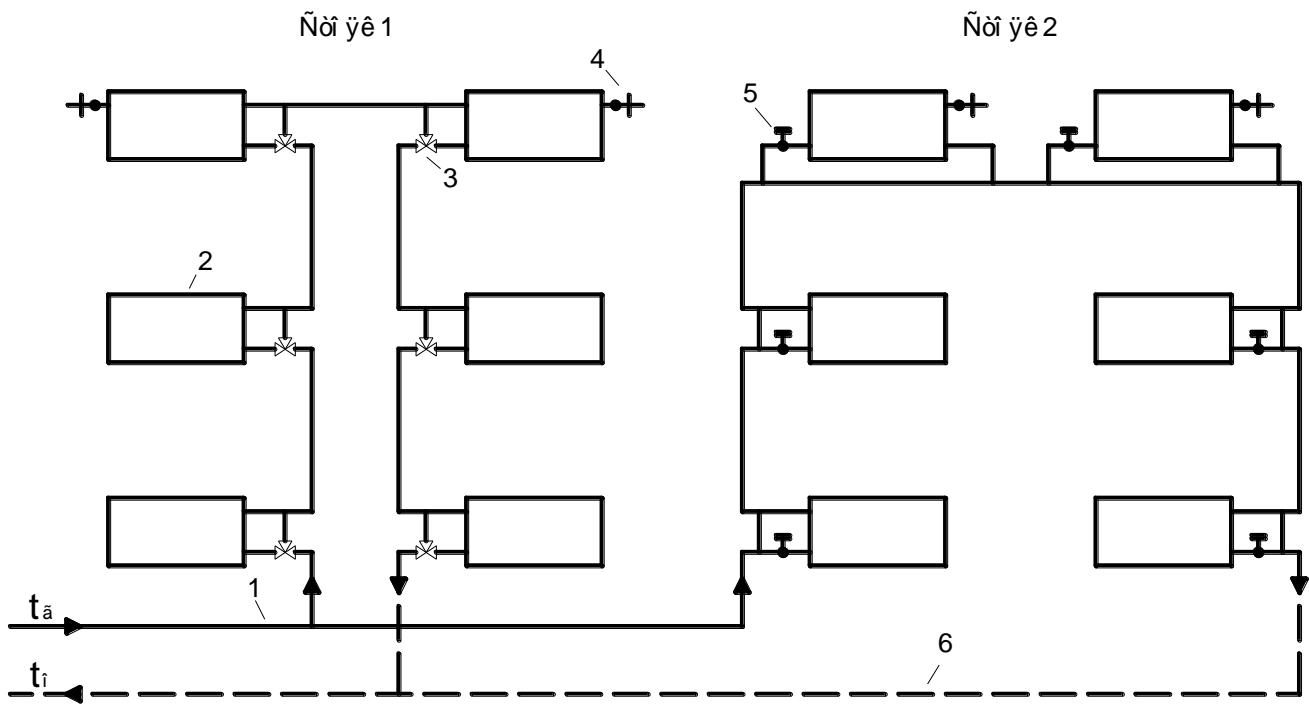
Схема однотрубной системы отопления с нижней разводкой и П-образными стояками
